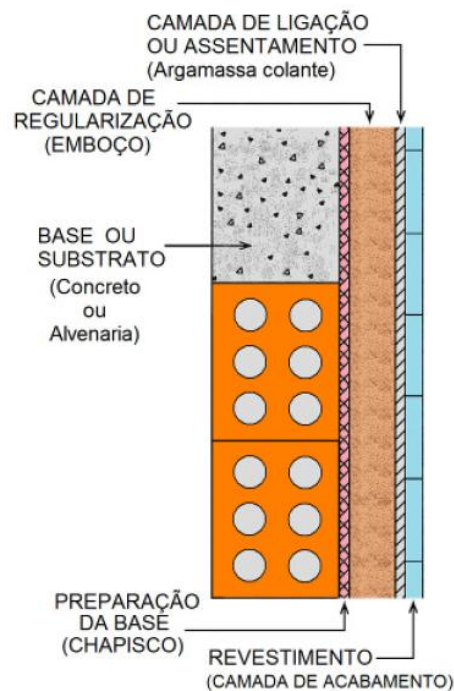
Esquemática das camadas da fachada em cerâmica.
